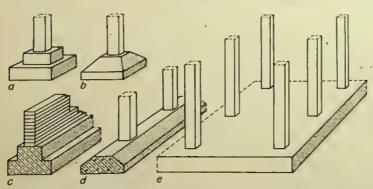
Flachgründungen: a Einzelfundament aus Stampfbeton und b aus Stahlbeton, c Streifenfundament unter einer Wand und d unter einer Stützenreihe, e Ausschnitt aus einer Fundamentplatte
